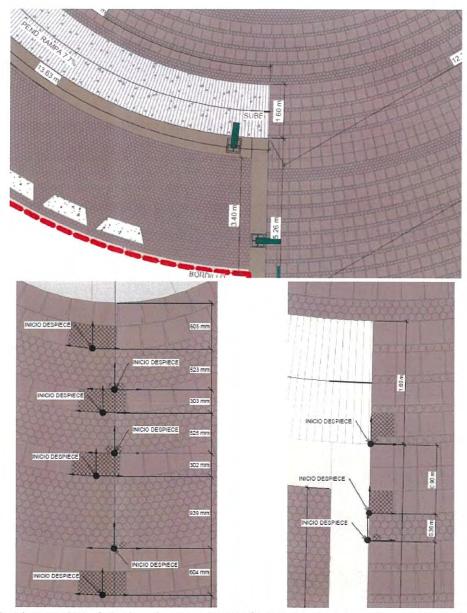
Despiece en planta de la plaza de acceso Rosario Castellanos, se observan las piezas precoladas cuadradas (30x30x6 cm) y las piezas cilíndricas (10 cm de diámetro con 6 cm de espesor).
